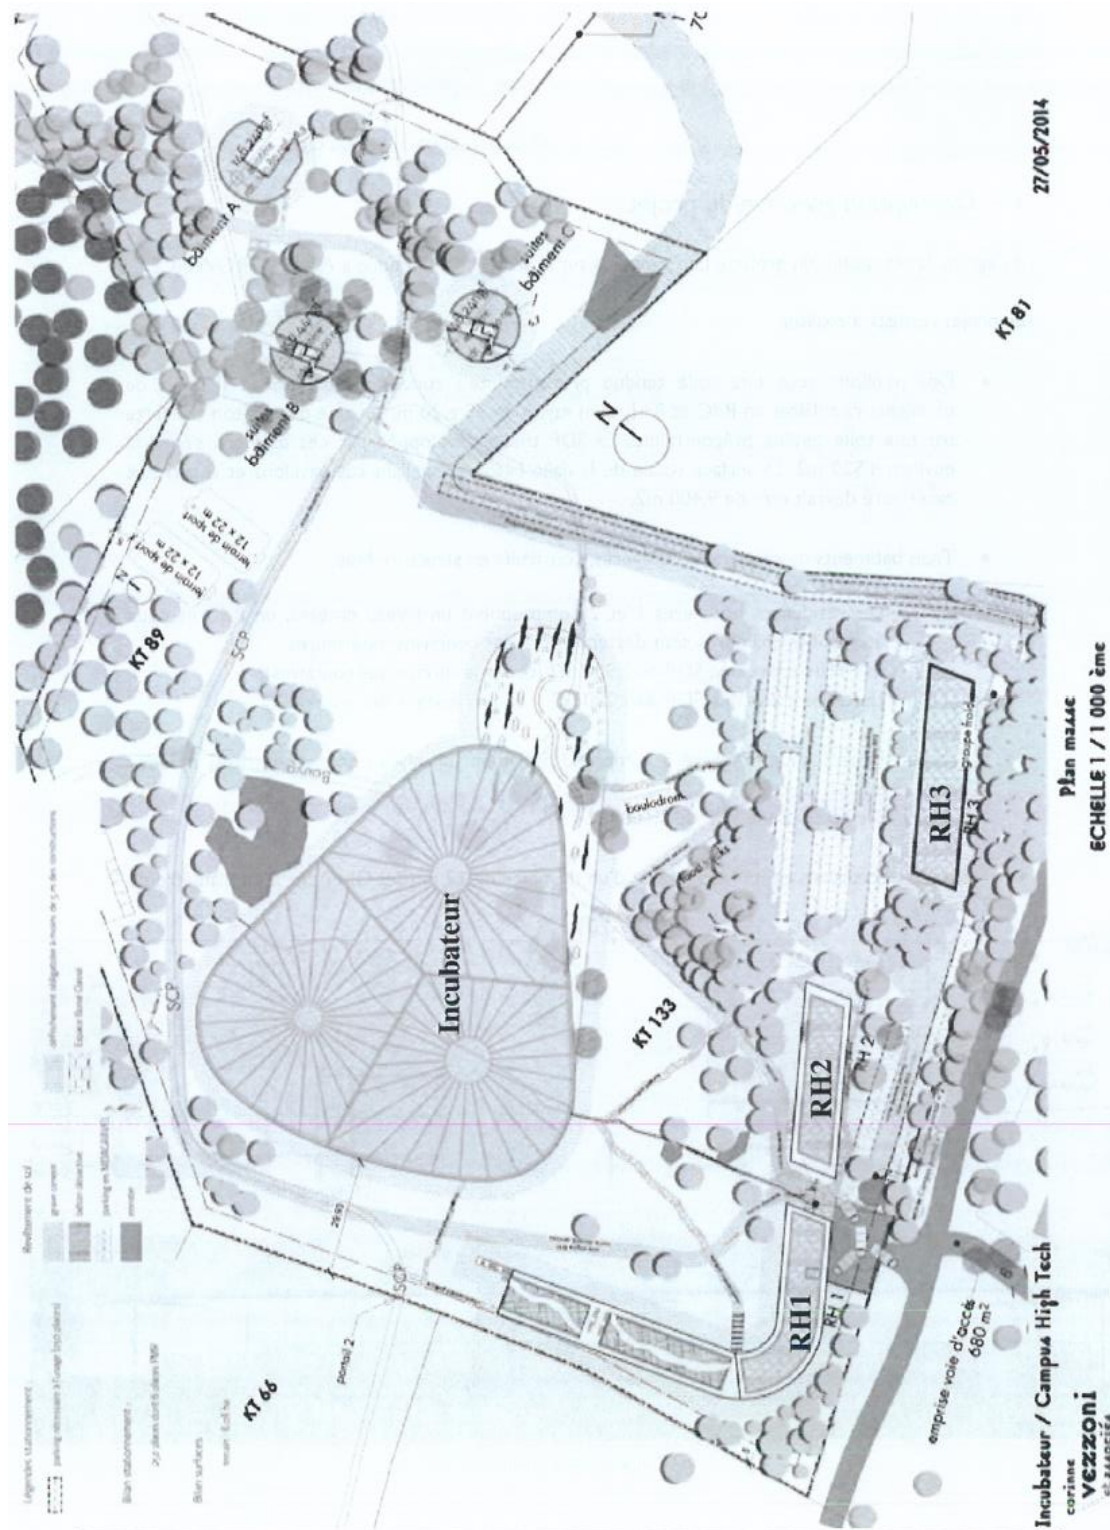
plan de masse initial du complexe The Camp (EI 2014 - AIRELE)
